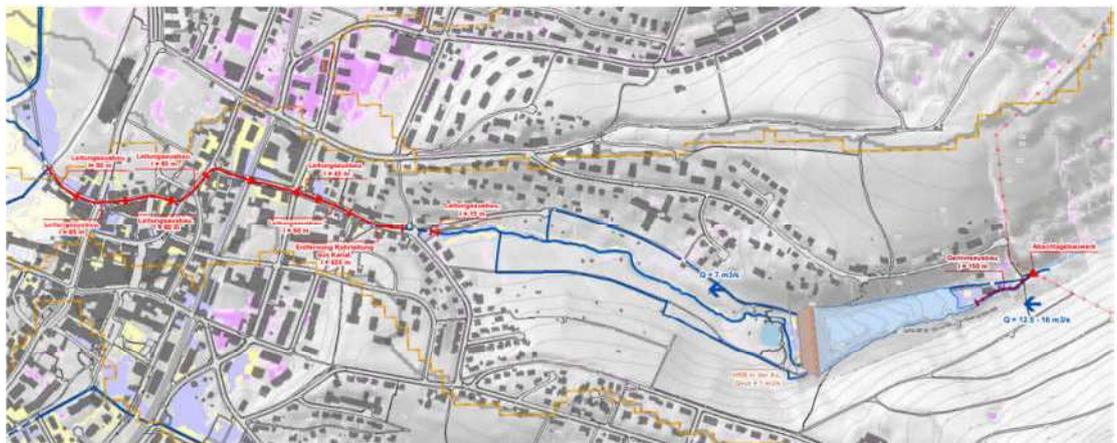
Ausschnitt aus dem Situationsplan Variante 3
